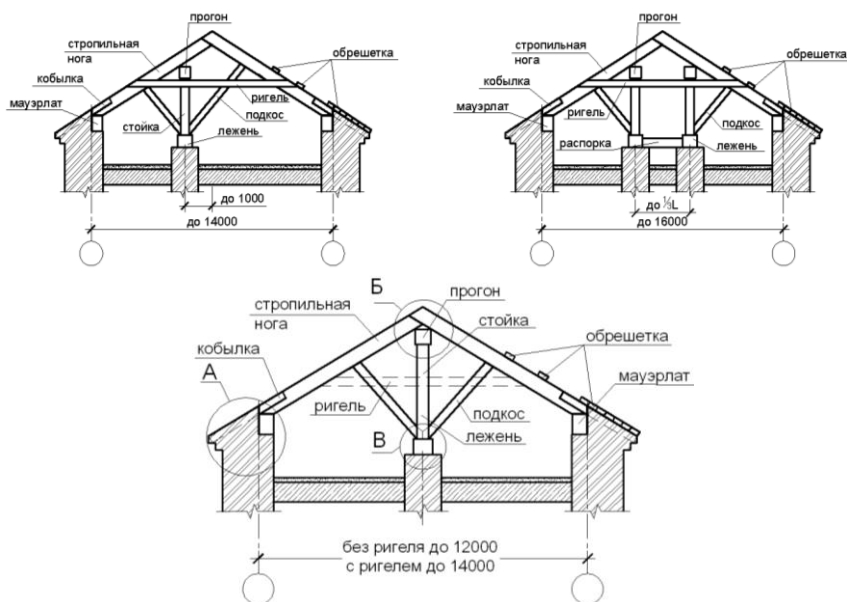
Конструктивные схемы двускатных крыш с наслонной стропильной системой
